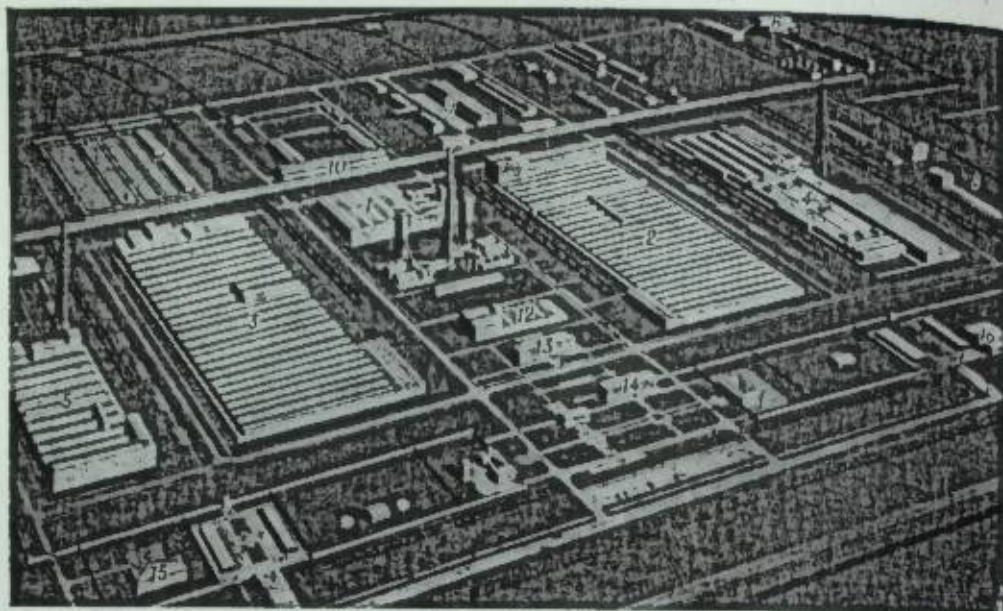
Комбинат искусственного волокна: 1 — корпус приготовления вискозы; 2 — южный корпус № 1; 3 — южный корпус № 2; 4 — главный корпус завода вискозного штапельного волокна; 5 — производство целлофана; 6 — сернокислотное производство; 7 — производство сероуглерода; 8 — установка кристаллизации; 9 — блок ремонтных цехов; 10 — водоумягчительная станция; 11 — газоочистительные установки; 12 — опытное произ-во; 13 — центр. лаборатория; 14 — водоуправление; 15 — учебный комбинат; 16 — гараж.
